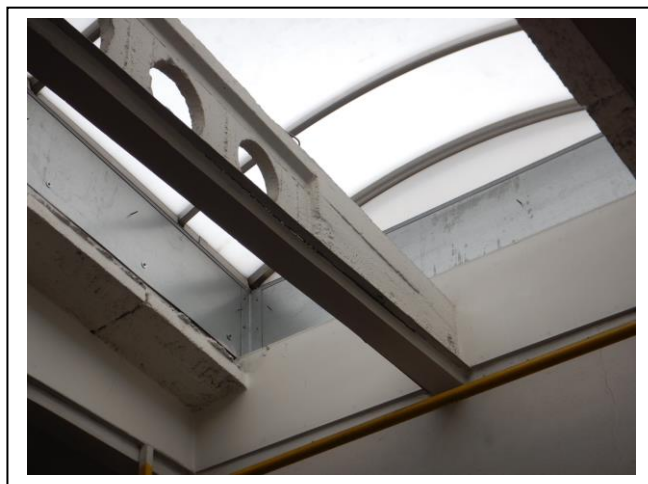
SS7 – střešní konstrukceFoto 118 – SS7 – střešní konstrukceFoto 119 – SS7 – střešní konstrukce
